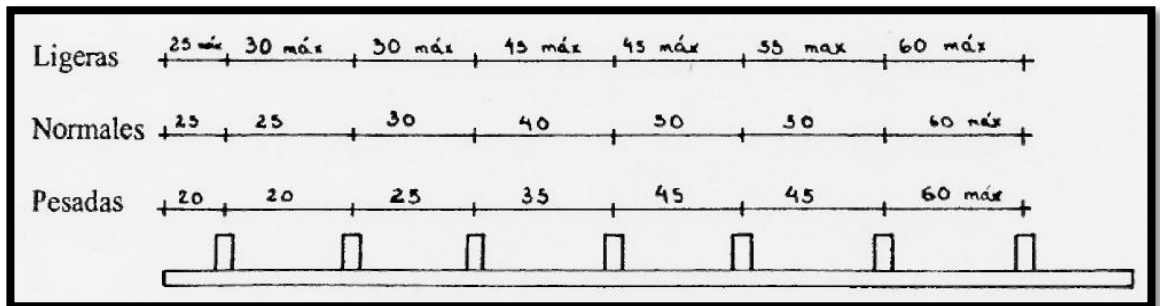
Separación de sepa según el tipo de columnas a construirse.
